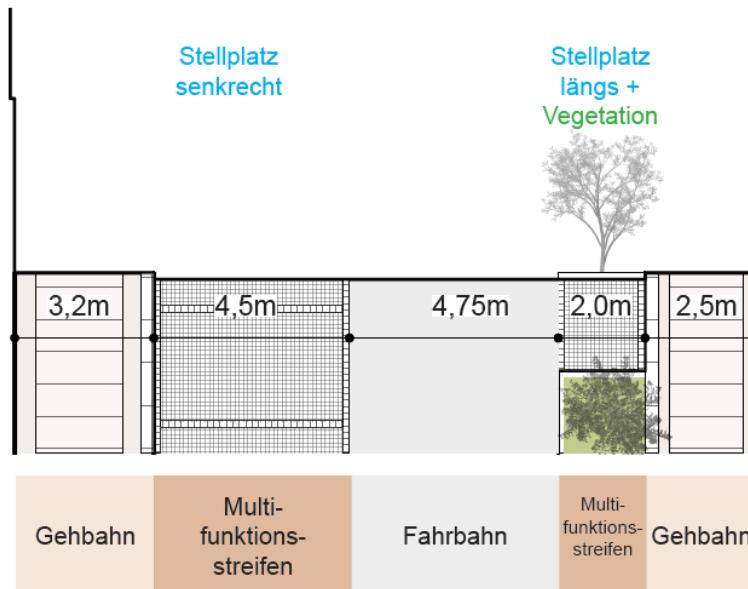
17m Straßenprofil – Prinzipschnitt mit Draufsicht
